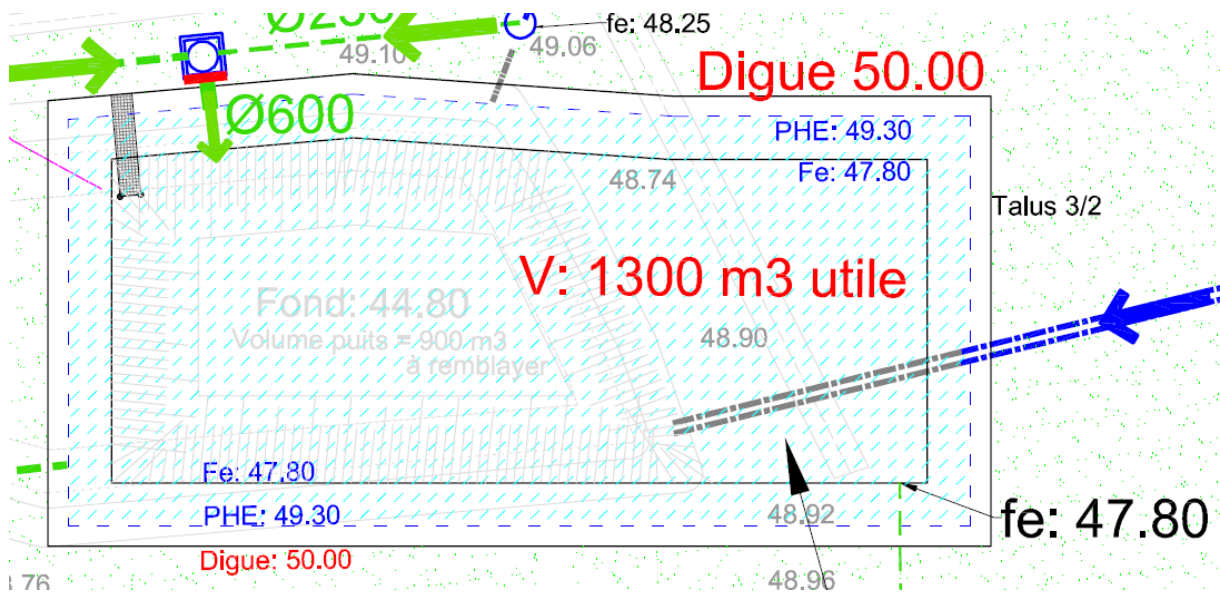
Extrait du plan de récolement des travaux de VRD, bassin n°1 (Source : Groupe RENOU, 2020)
